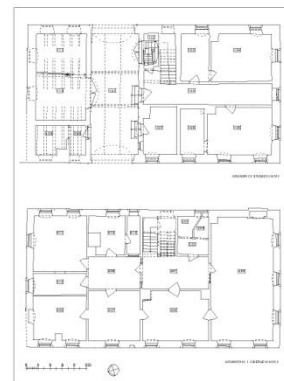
Grundriss Erdgeschoss und Obergeschoss
